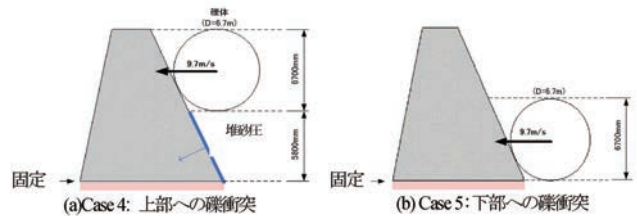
コンクリート堰堤本体への礫衝突 (礫径6.7 m)
